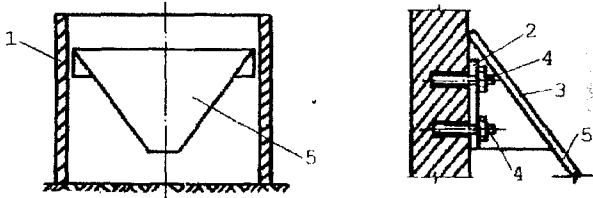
Крепление закладных элементов к стенам силосных сооружений с помощью клеевых анкеров периодического профиля: 1 – железобетонная стена силосного сооружения; 2 – клеевой шов; 3 – закладной элемент крепления; 4 – анкер периодического профиля; 5 – стальная воронка
